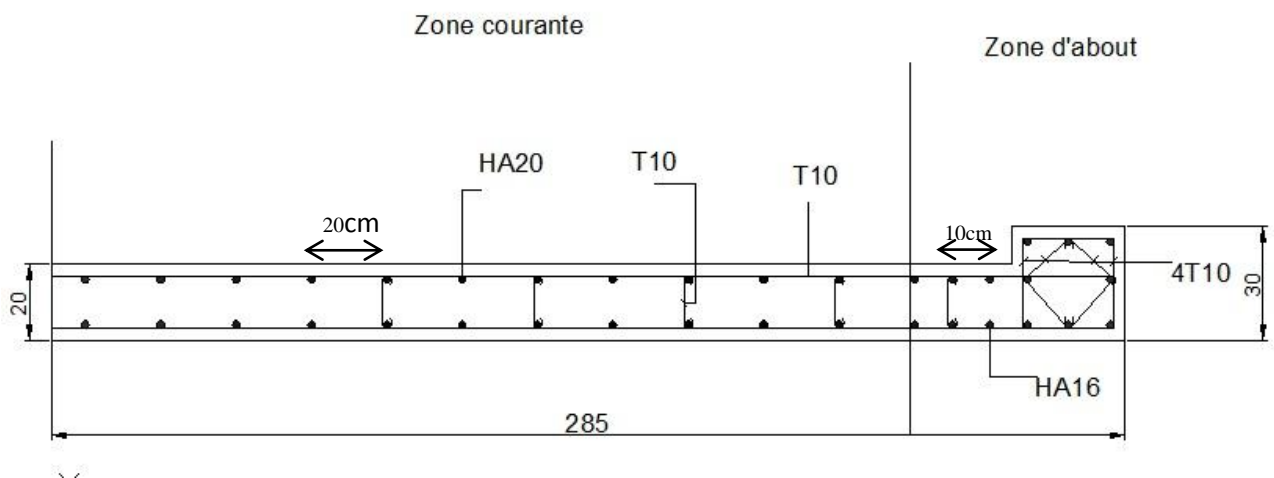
croquis de ferrailage de voile V1 en zone 1
